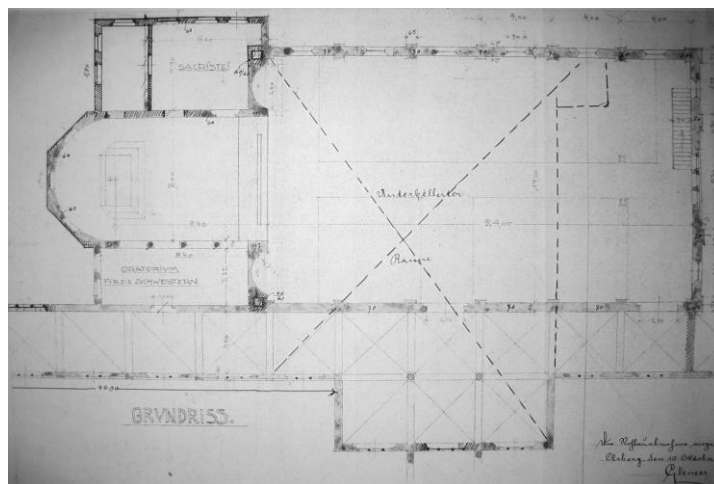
Grundriss, 19.08.1915
